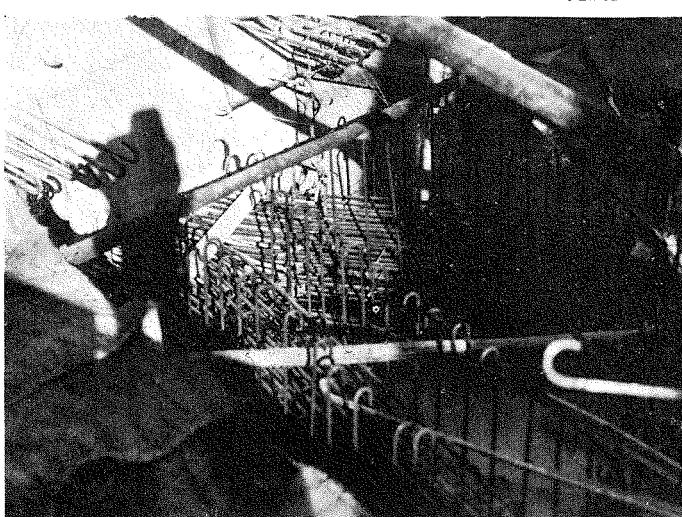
ドラフトチューブ周囲の鉄筋コンクリートピーム。
